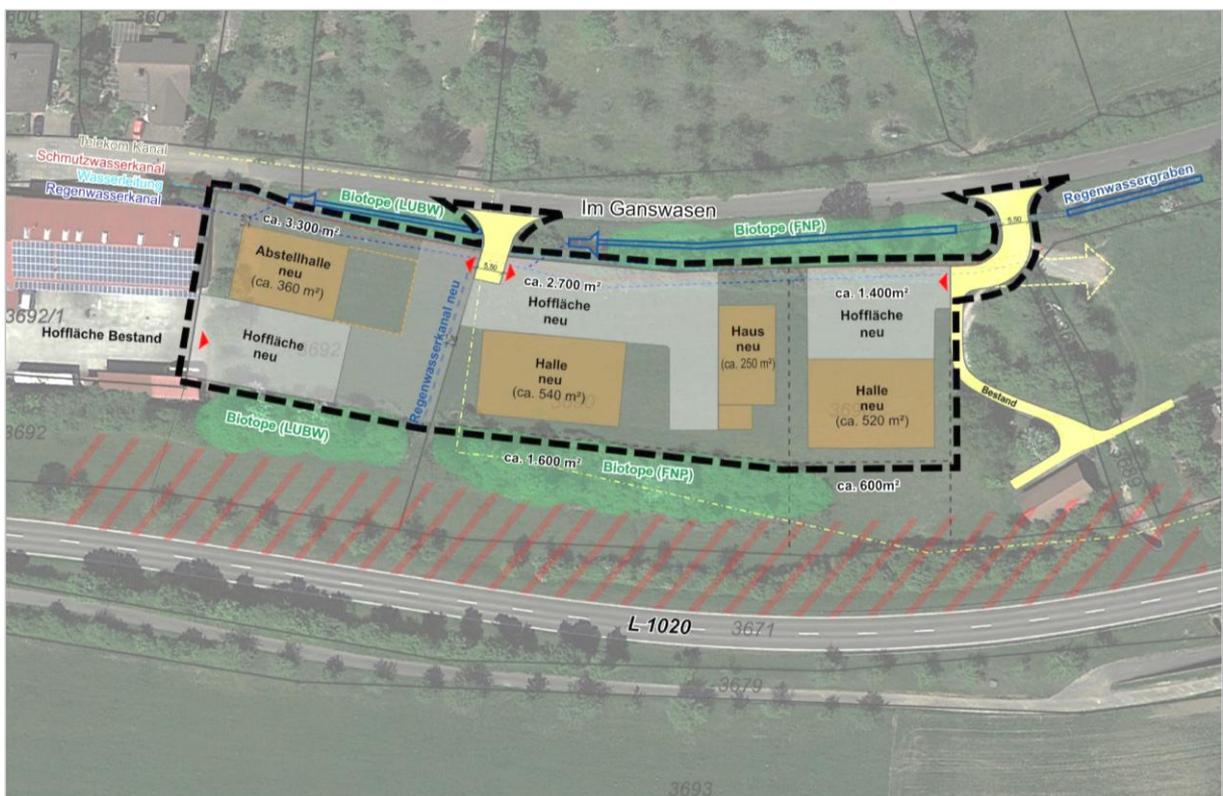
Städtebaulicher Entwurf – Variante 2 (Planungsgruppe SSW GmbH, 24.04.2024, Ausschnitt o. M.)
